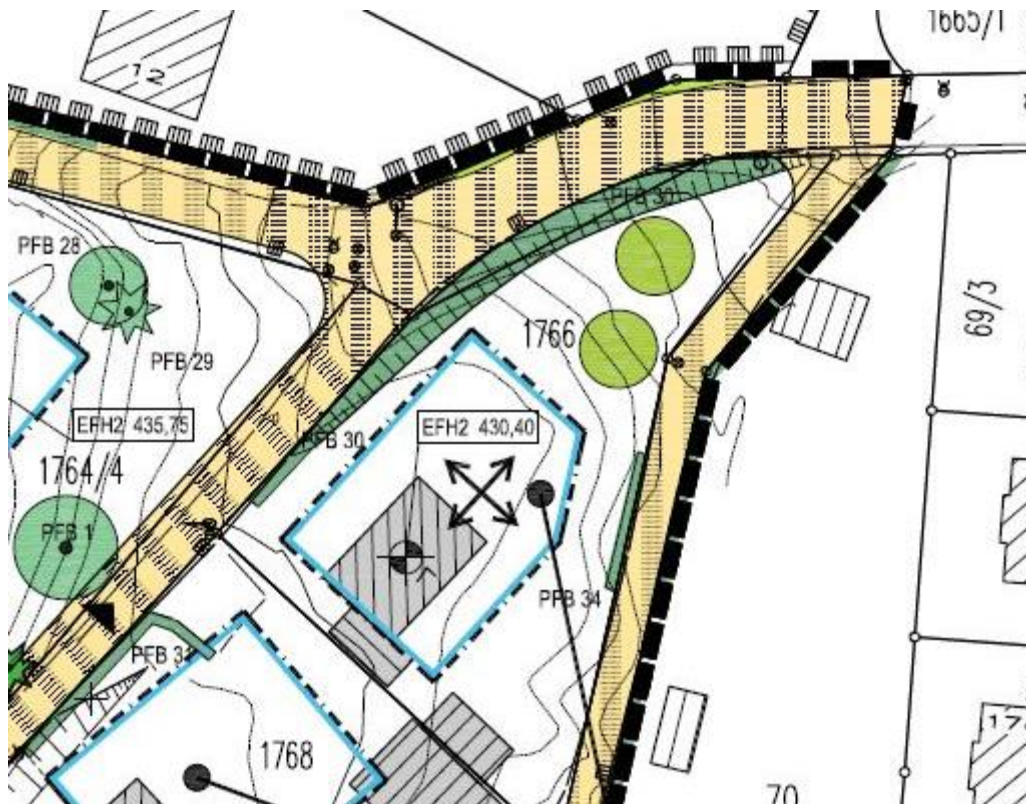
Baugesuch, Grundriss<sup>25</sup>
